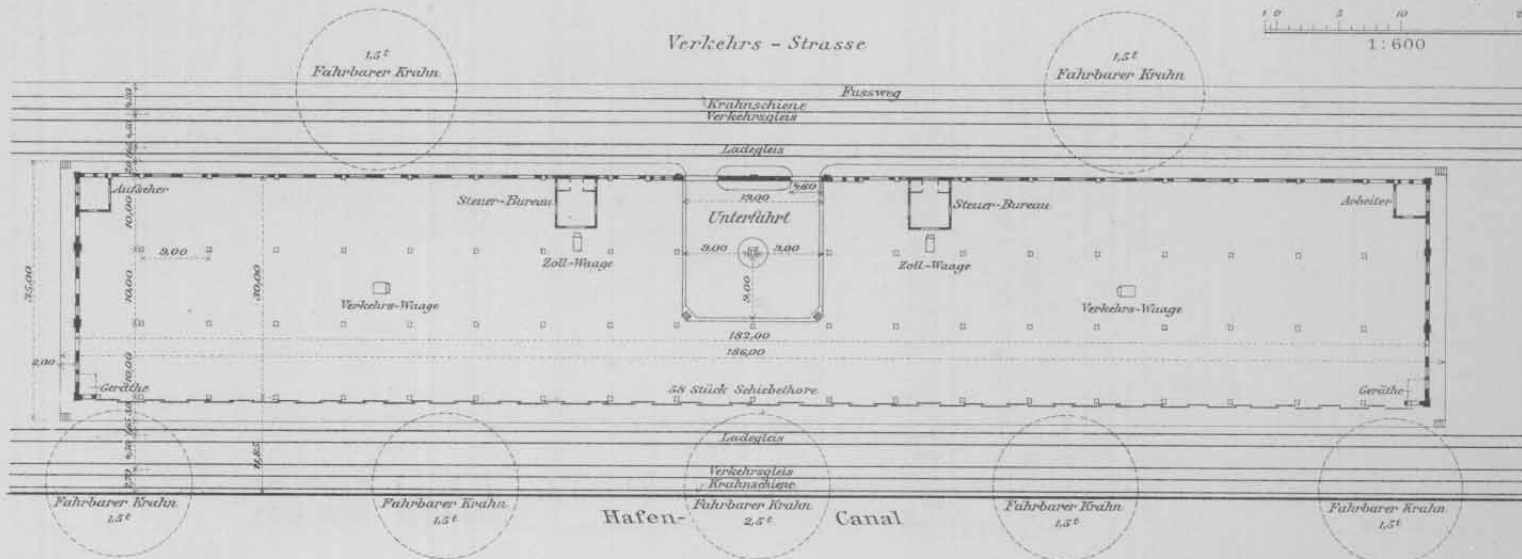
Grundriss des Kaischuppens. 1:1000.
